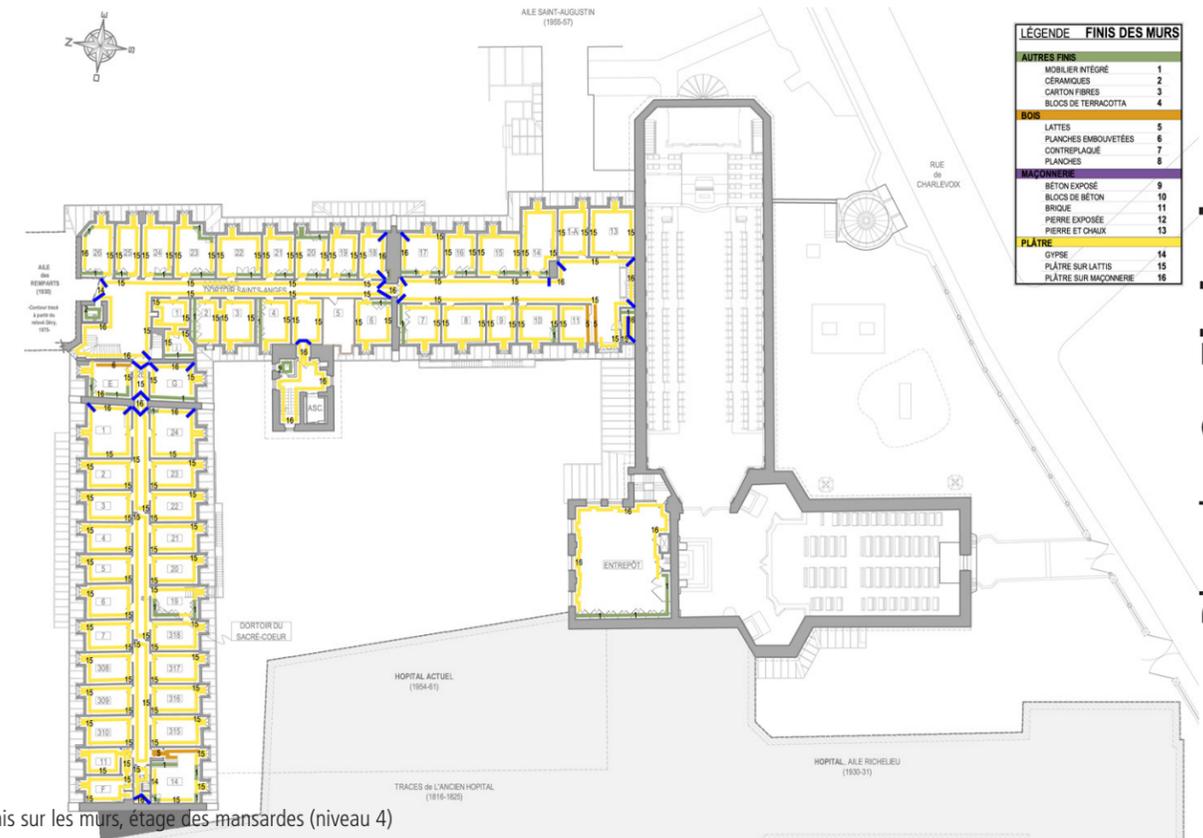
Plan des finis sur les murs, étage des mansards (niveau 4)
